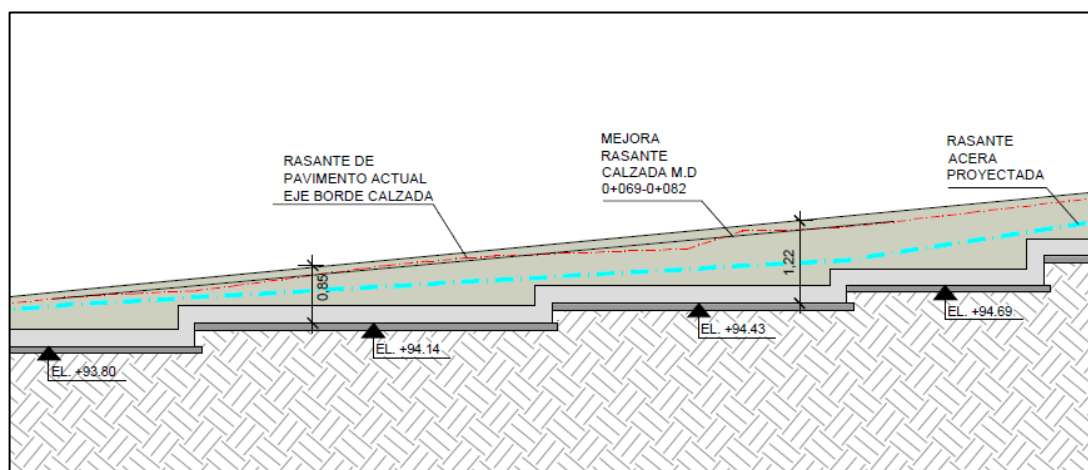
Propuesta mejora rasante longitudinal calzada
